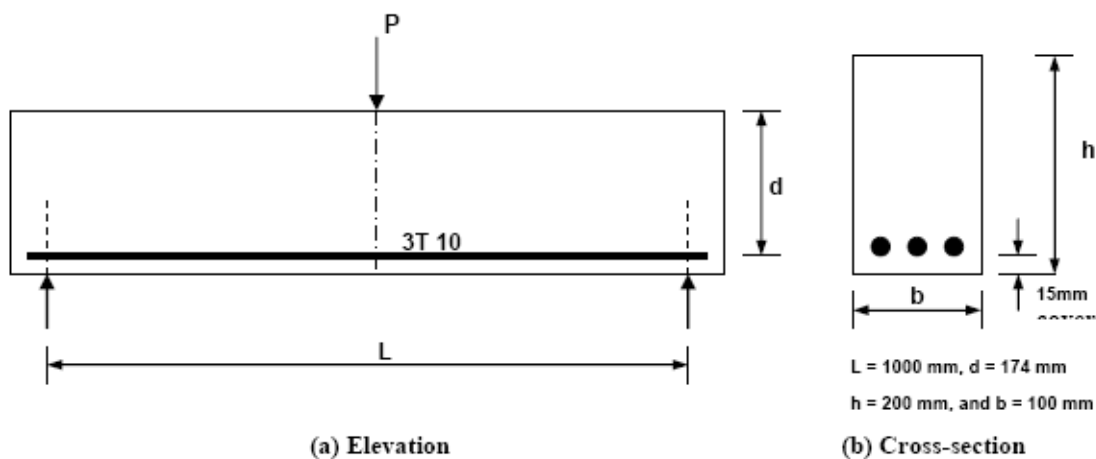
鋼筋混凝土樑支承及千斤頂受力配置圖
